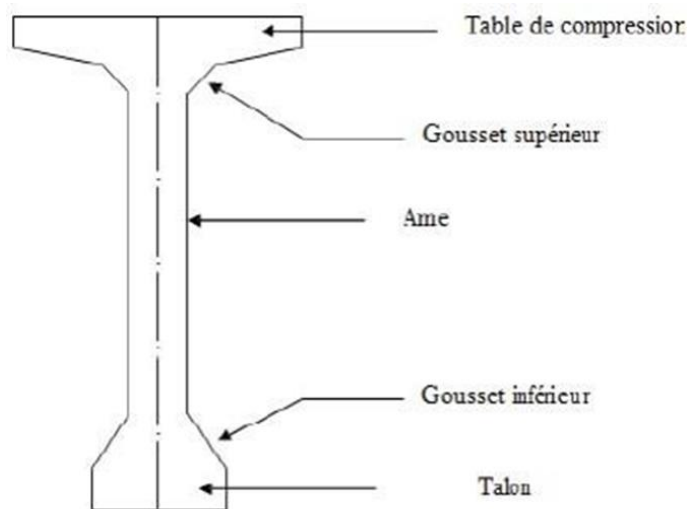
COUPE TRANSVERSALE D'UNE POUTRE
